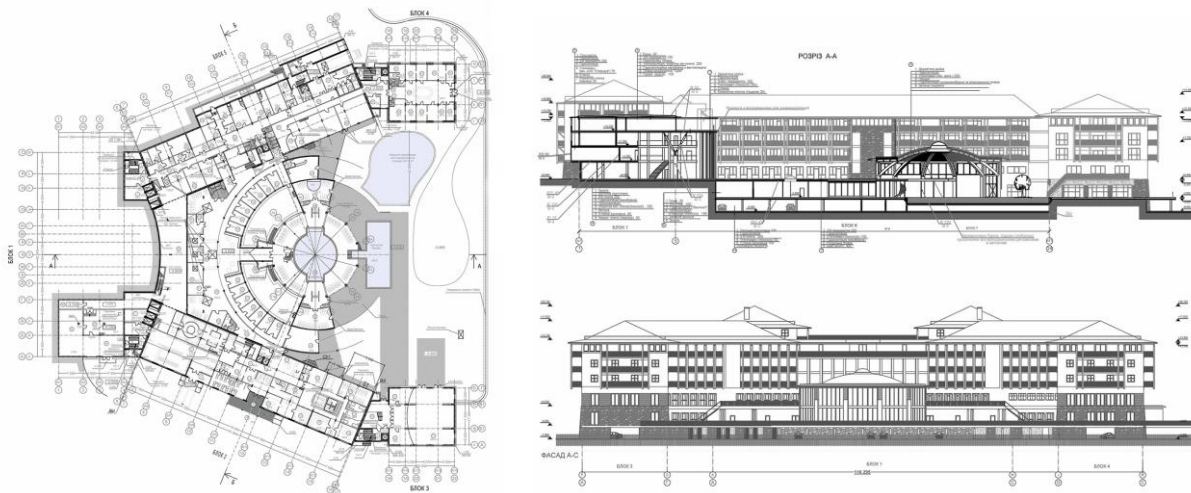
План, розріз та фасад готелю Radisson Blu Resort
